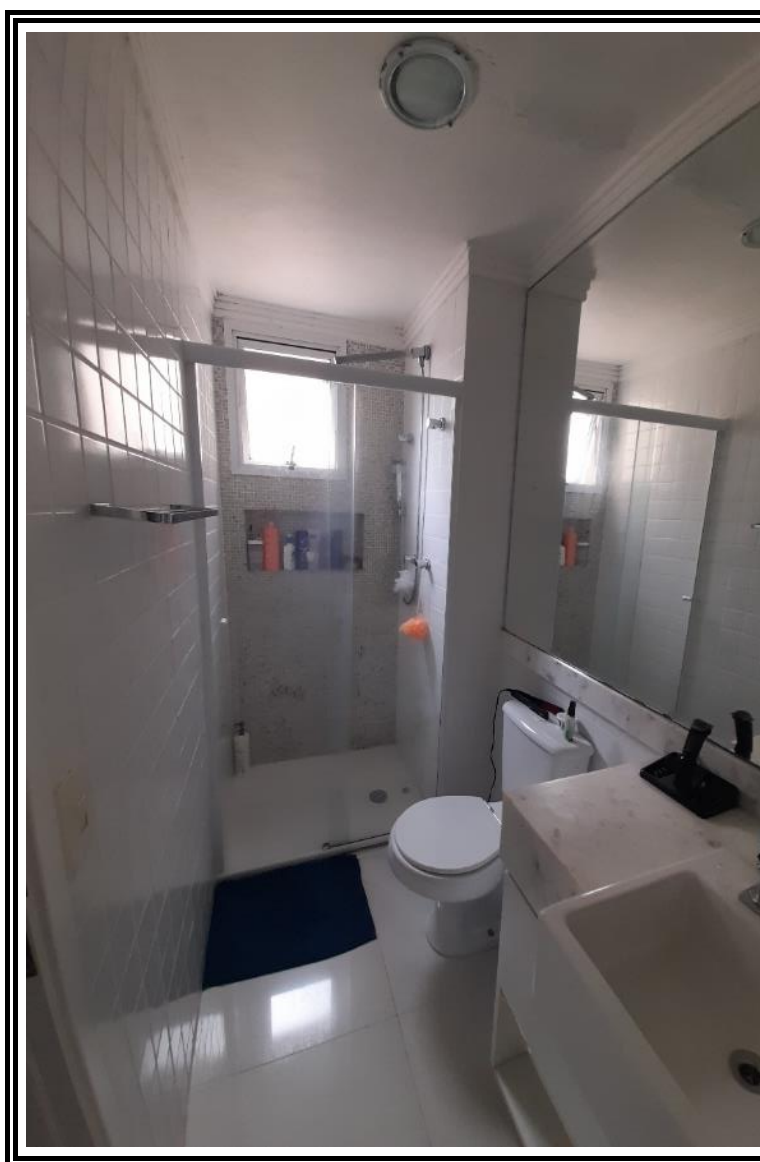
Vista do banheiro do dormitório 01 (suíte)
